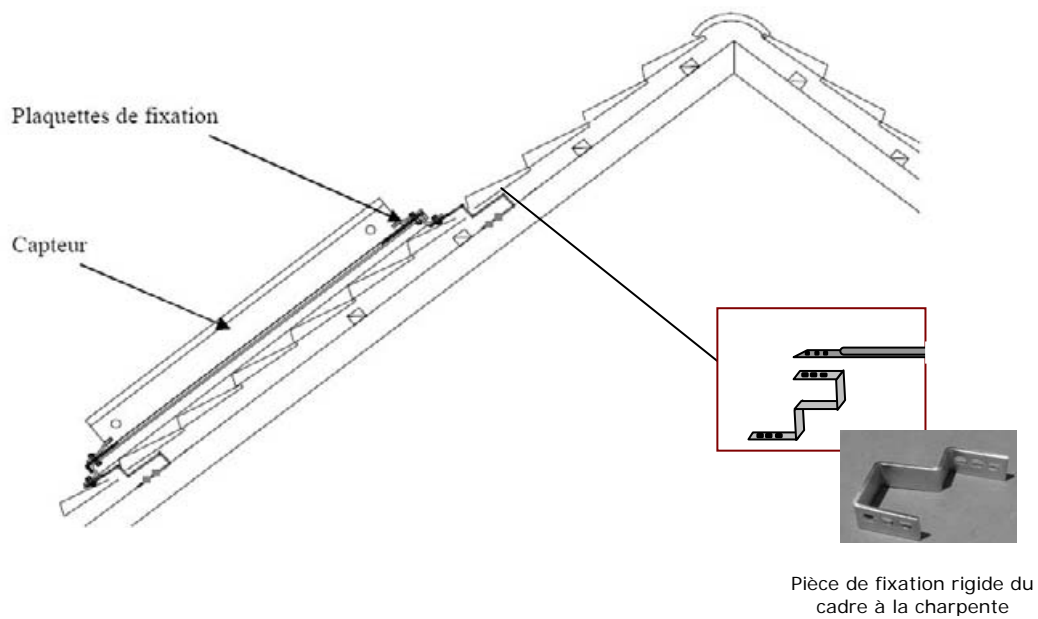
Kit pour 1 capteur sur toiture inclinée
